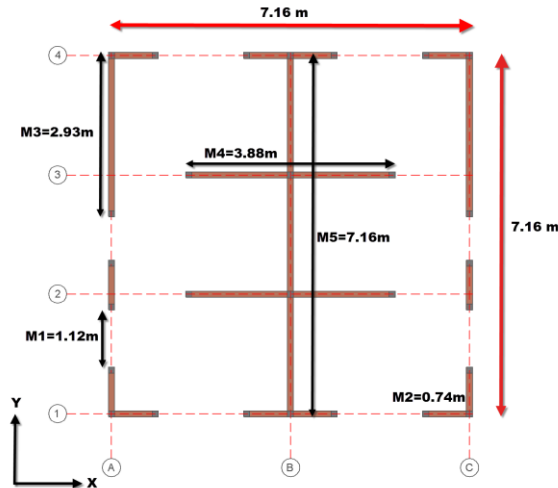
Vista en planta del sistema estructural (Arias, 2005)
